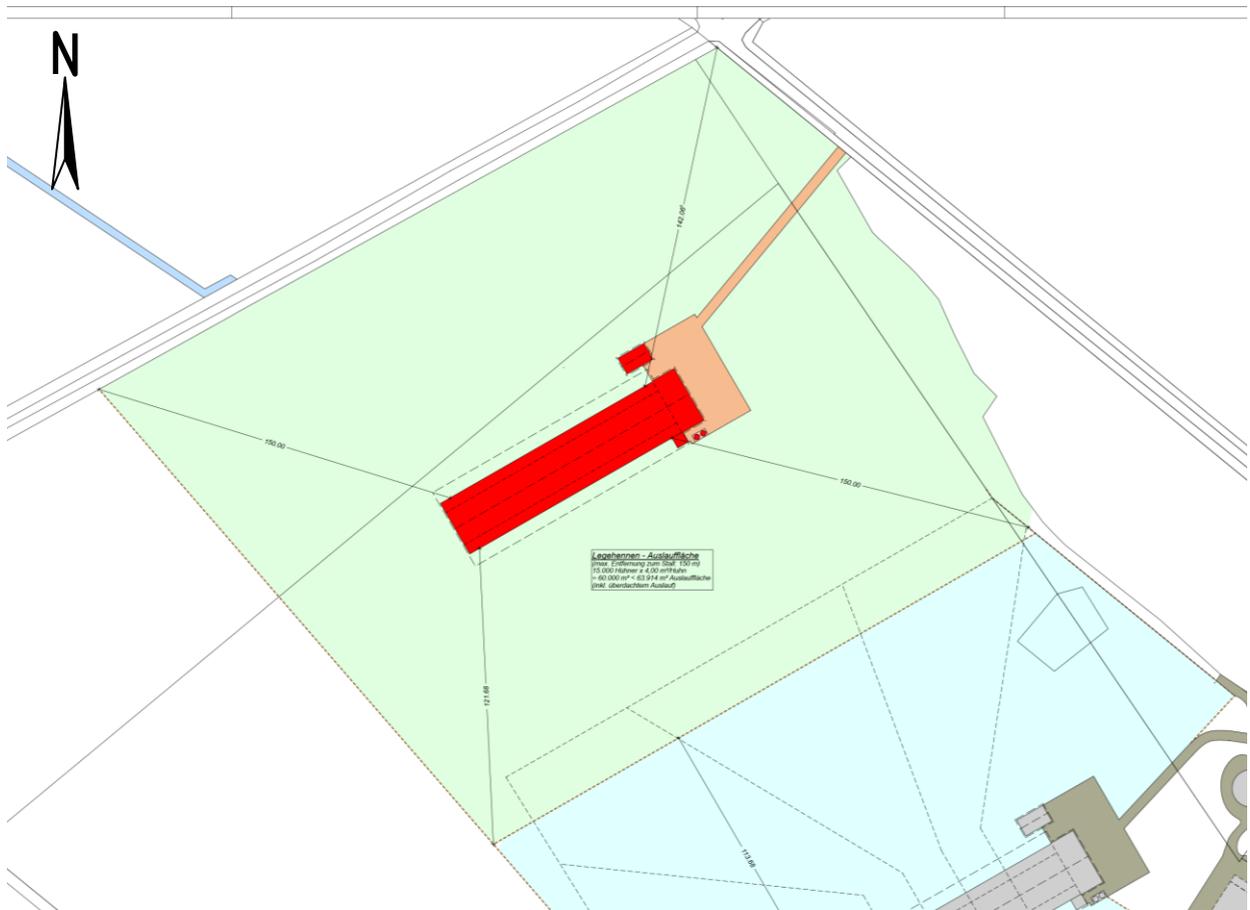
Lageplan der geplanten Anlage (Skizze, Stand 18.1.2024)
